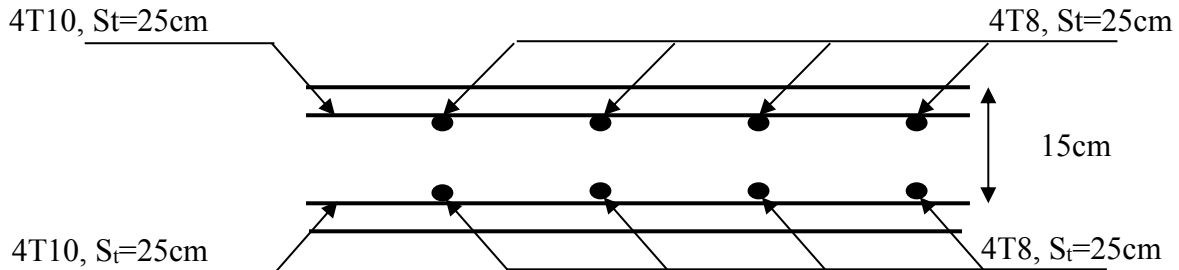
Schéma de ferrailage de la dalle d'ascenseur
